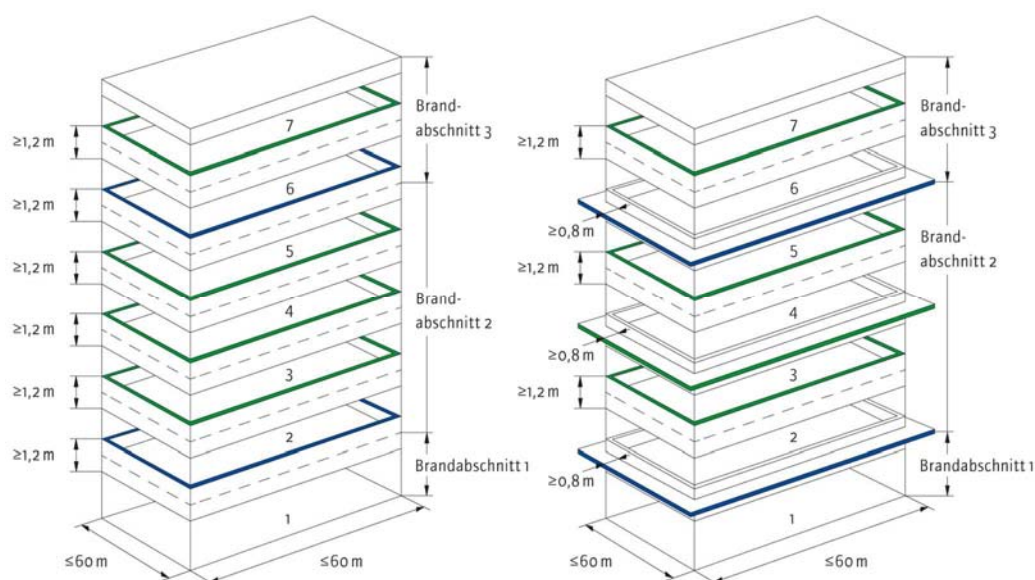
Anforderungen an Brandabschnitte und deckenübergreifende Außenwandstreifen bei GK 5 mit mehr als sechs oberirdischen GeschöÙen (nicht Wohngebäude) Quelle: proHolz/HFA
